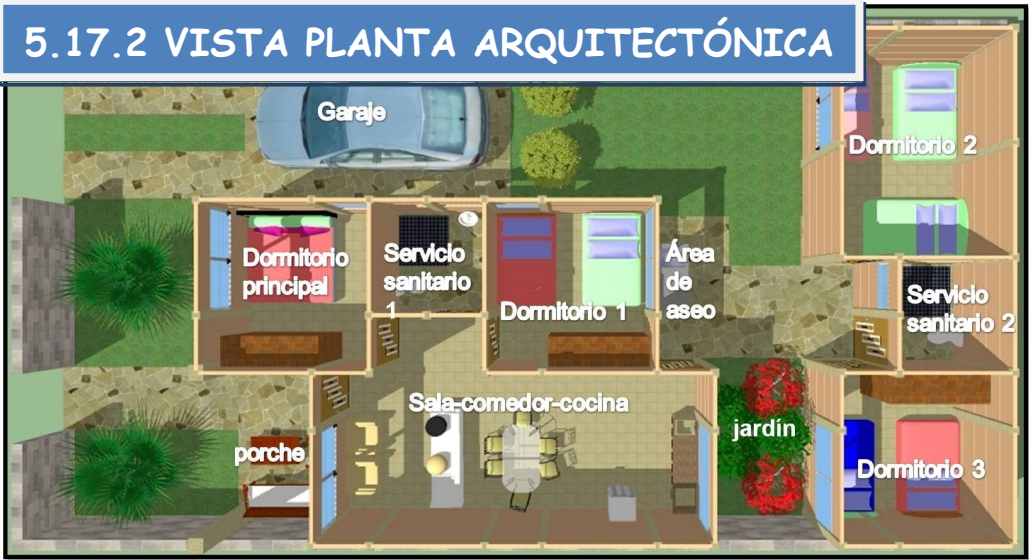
Vista planta arquitectónica del modelo de vivienda Otoño, de la urbanización Valle verde en San Pedro de Lóvago, Chontales.
